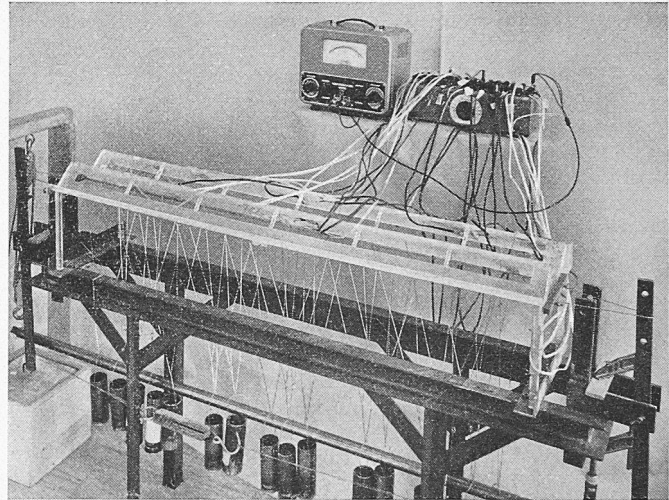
Plexiglasmodell 1:25 mit Belastungsvorrichtung und Messbrücke
